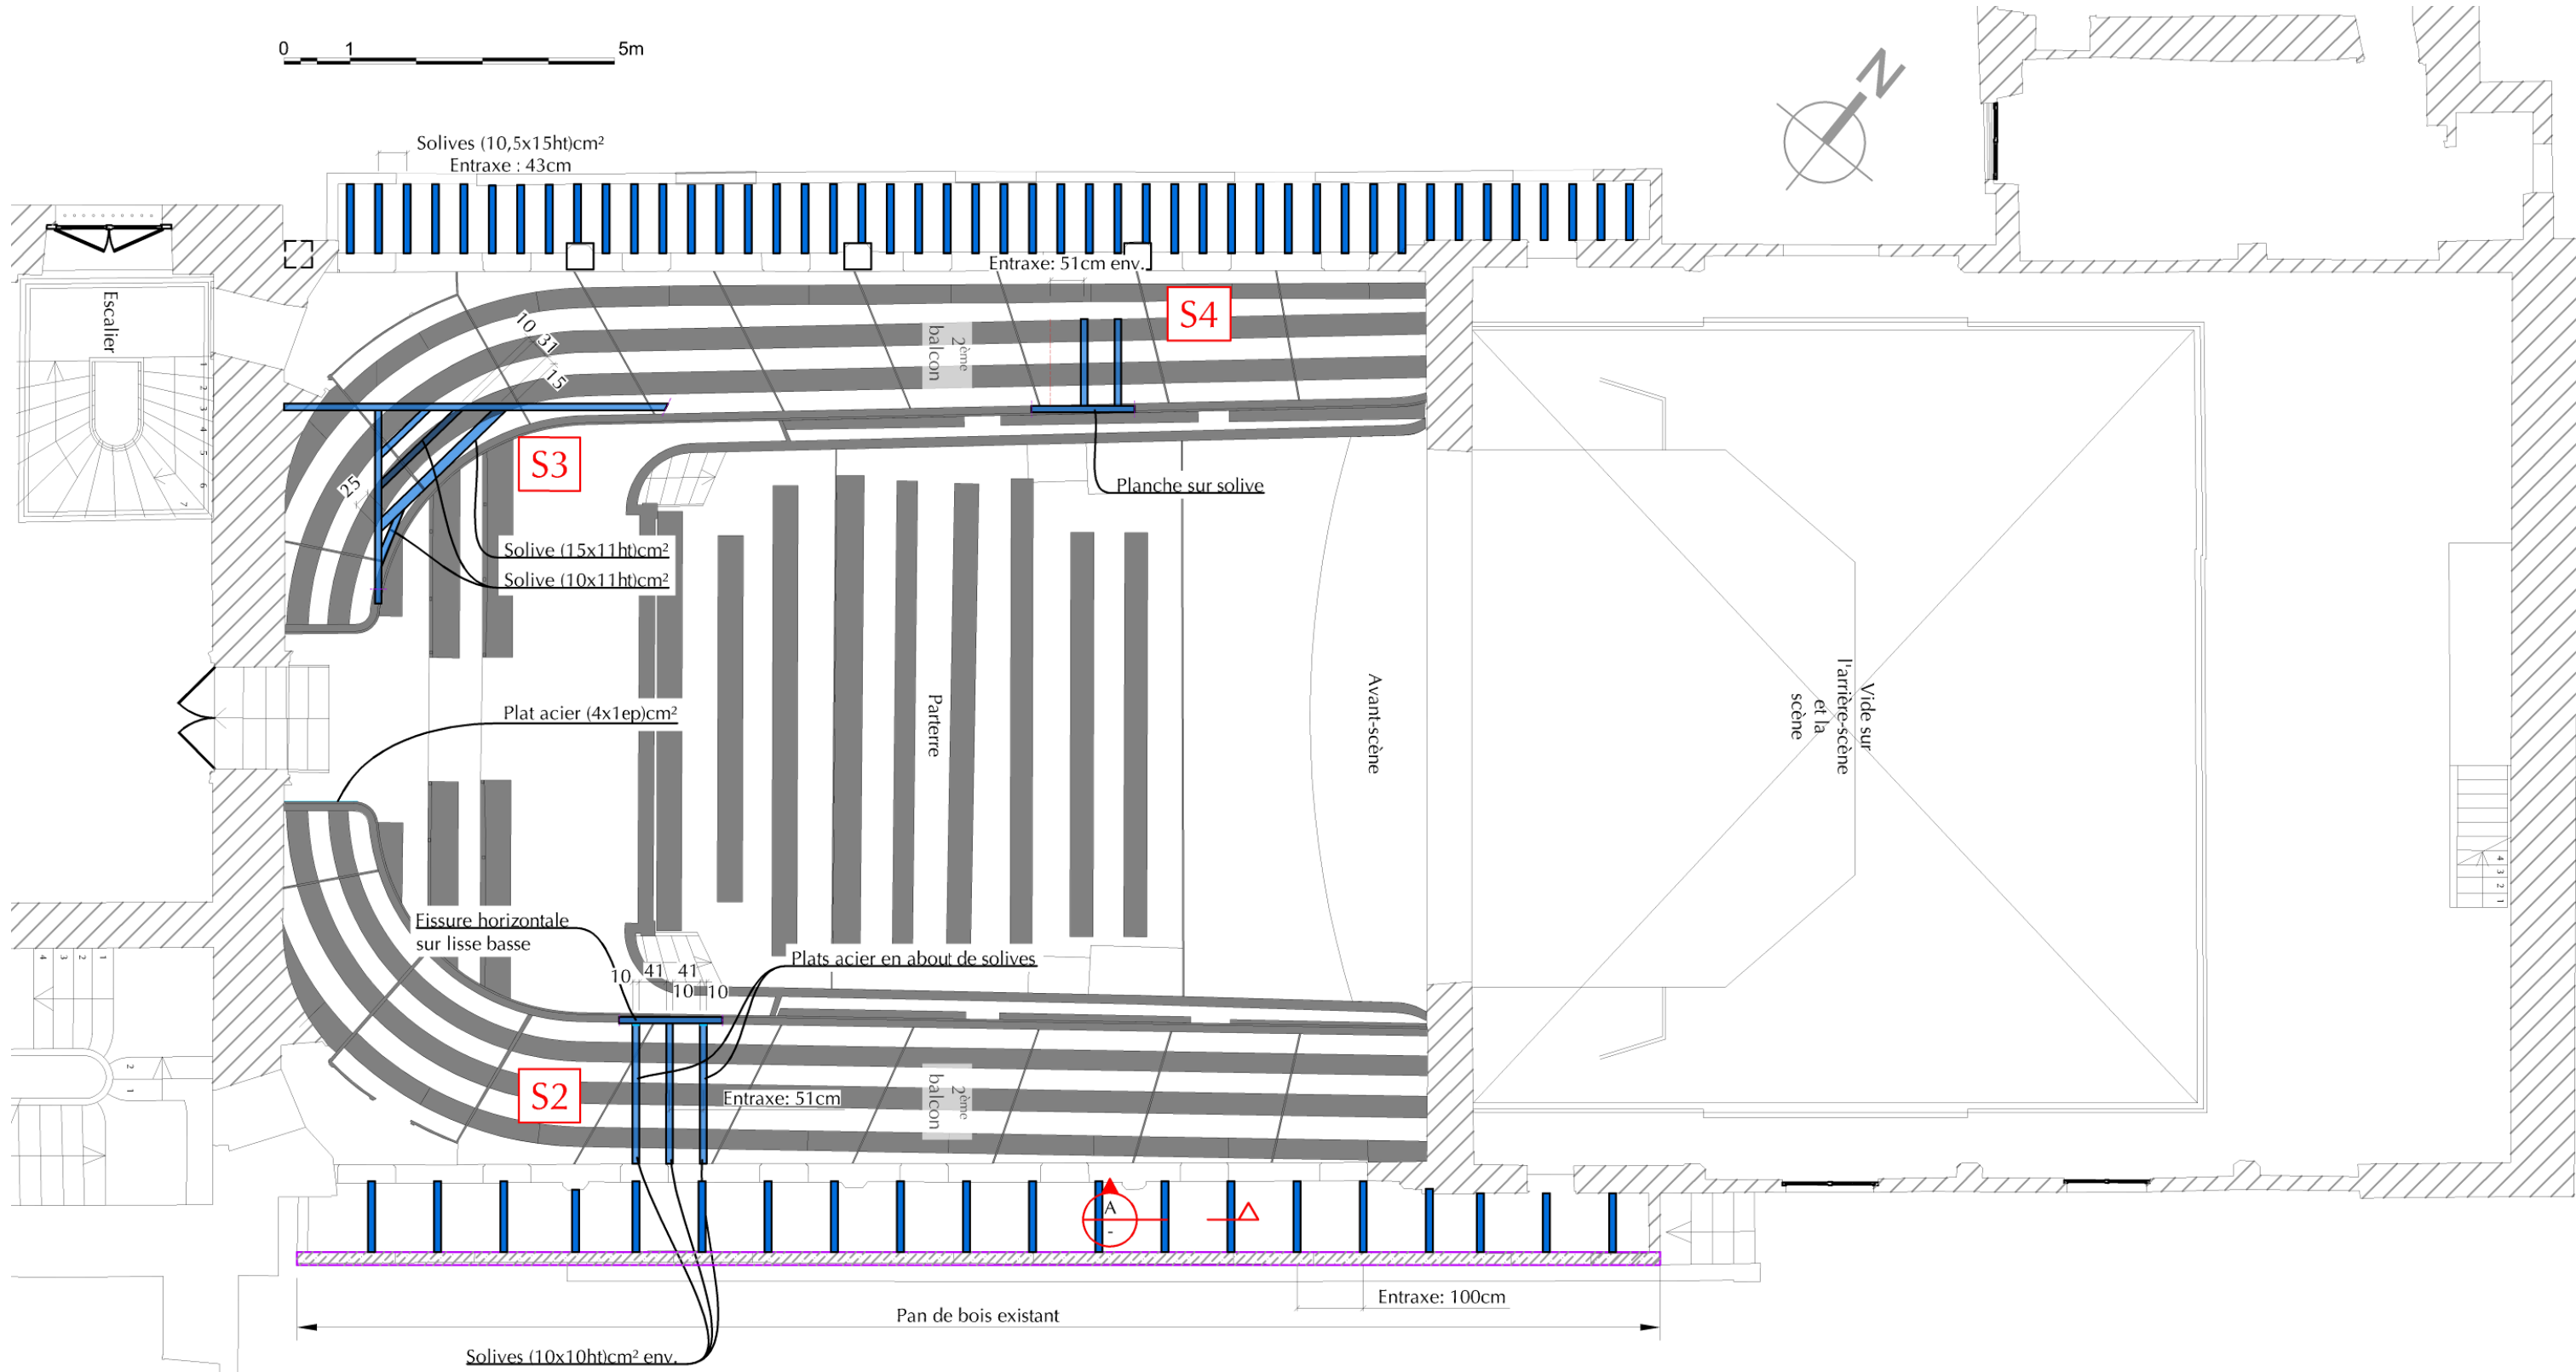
Vue plan du 2^{ème} balcon – Plan de localisation sondage
